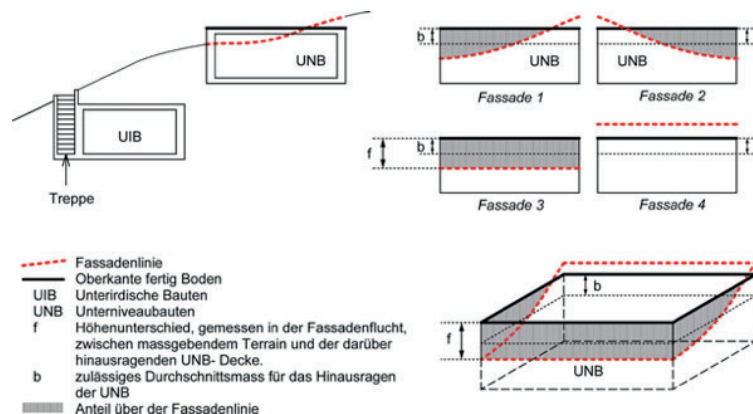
Unterniveaubauten (UNB) und unterirdische Bauten (UIB)
